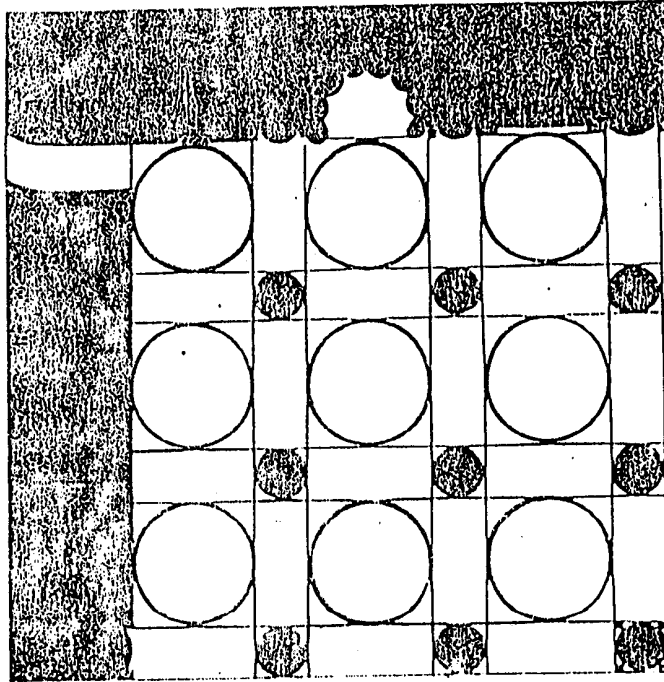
مسقط أفقي لمسجد السيدة بالمنستير بتونس (عن : Marçais)
